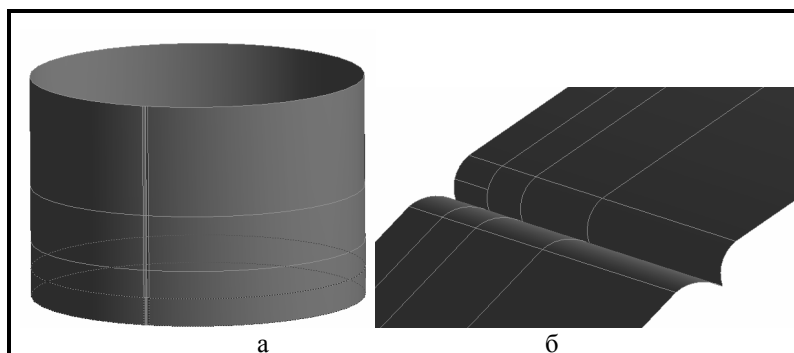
Модель резервуара с угловатостью в области сварного шва: а – эскиз резервуара; б – вид угловатости сварного шва
